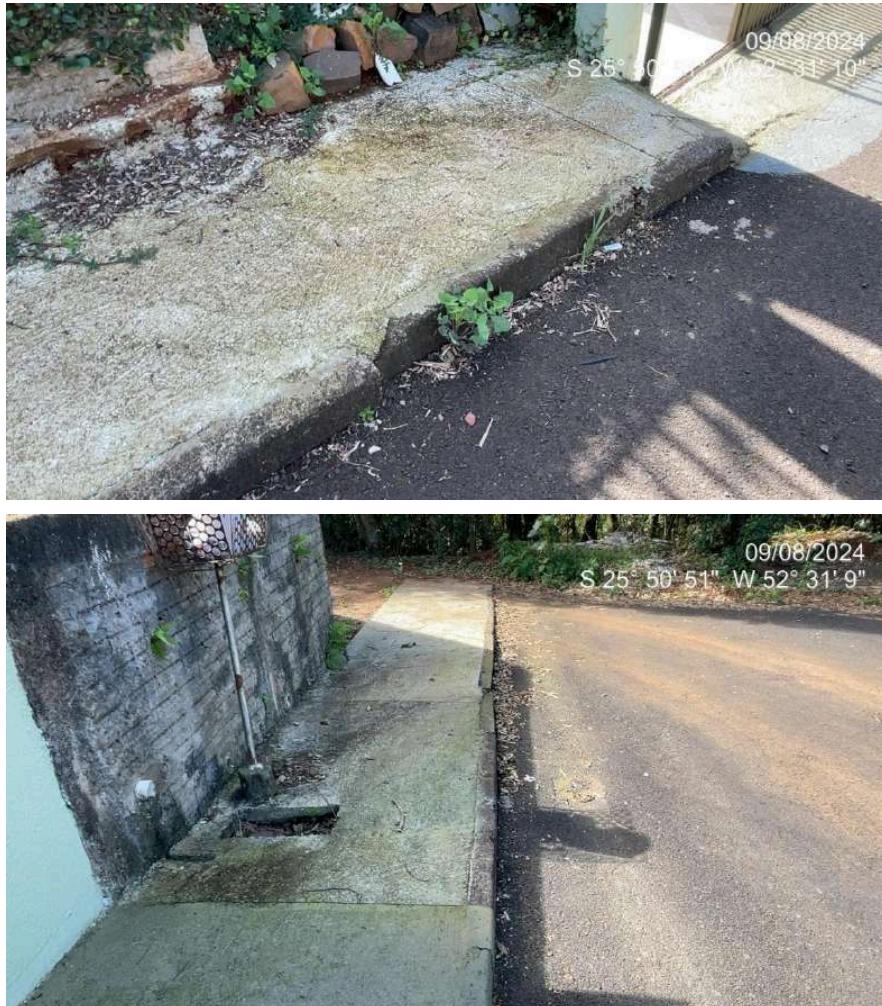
Calçada em concreto na Tva. Alferes Joaquim Ferreira com baixa qualidade executiva, meio-fio desalinhado.
